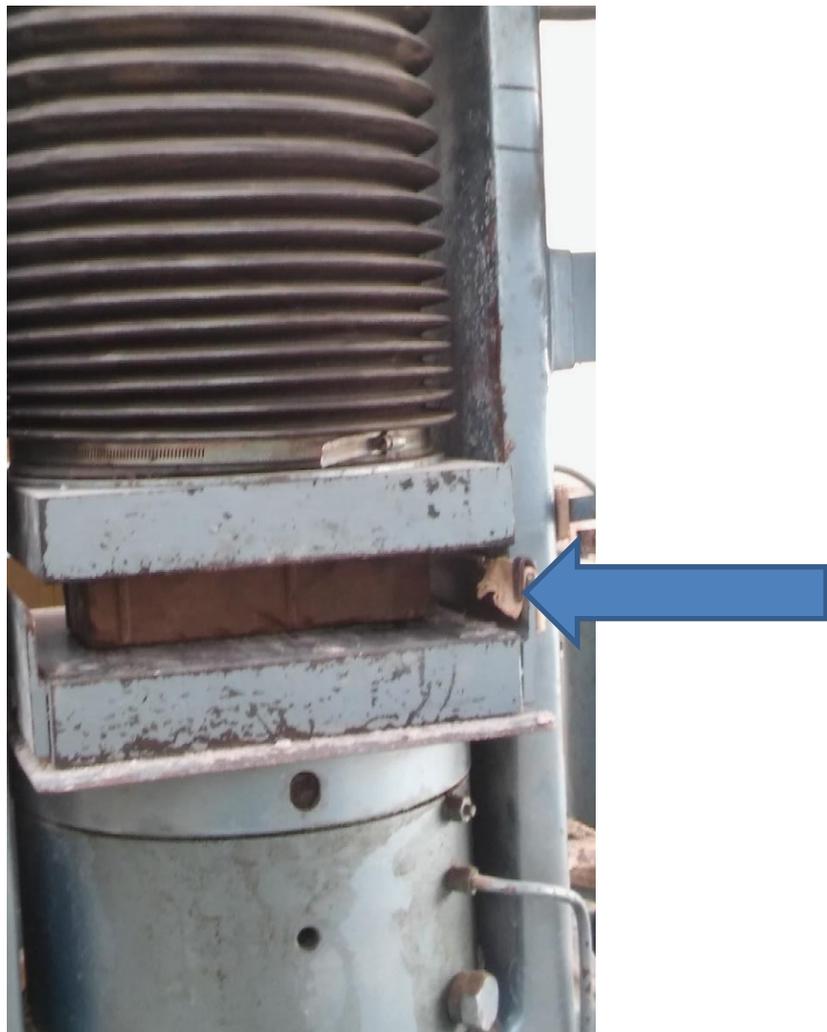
Realizando el Ensayo a la Compresión de la Muestra de Adoquín de Concreto
